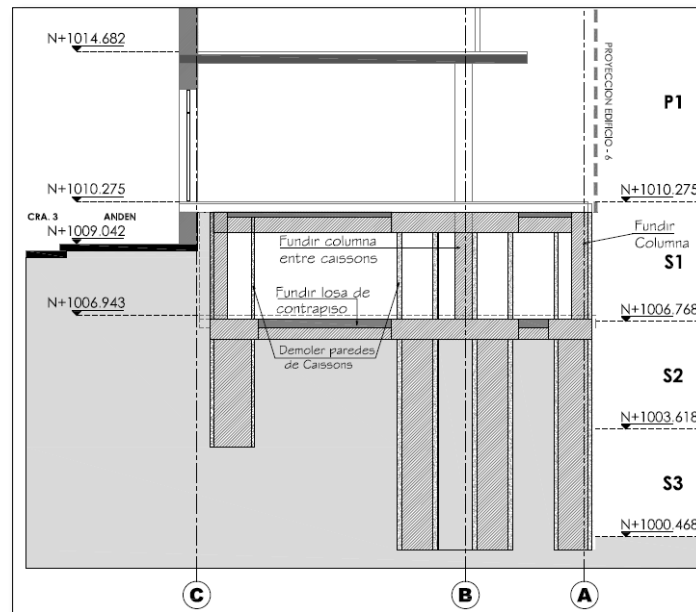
Sección Paso No. 5 Alternativa 1 – Demolición de anillos.
